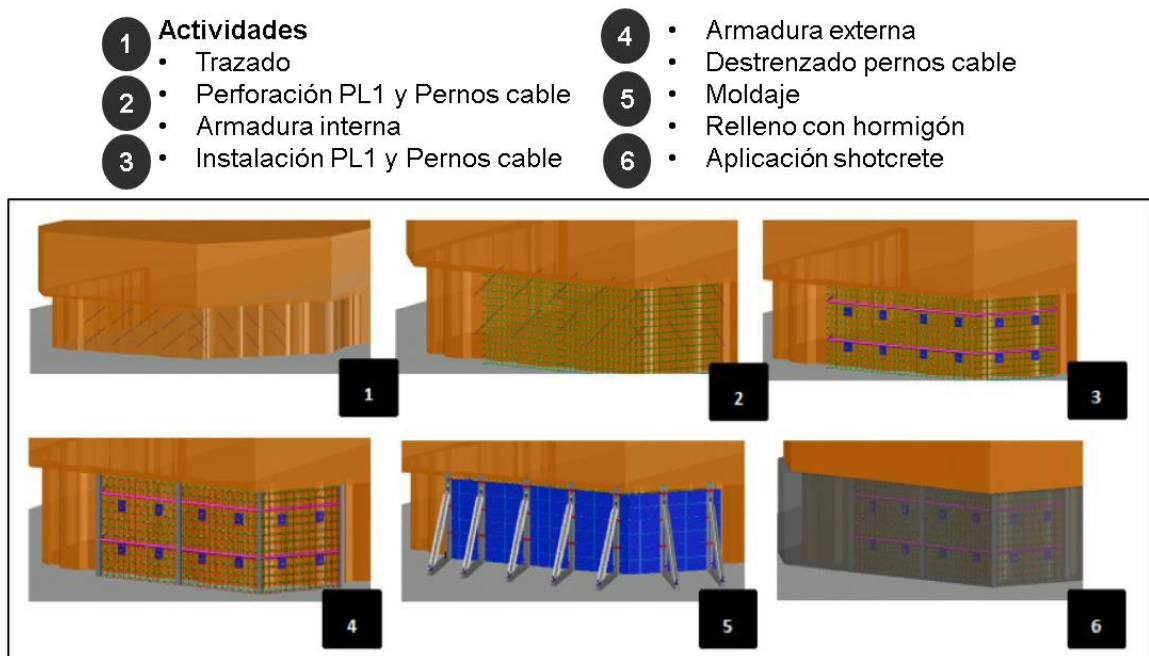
Secuencia de Construcción de un Muro de Confinamiento MB central [1].
